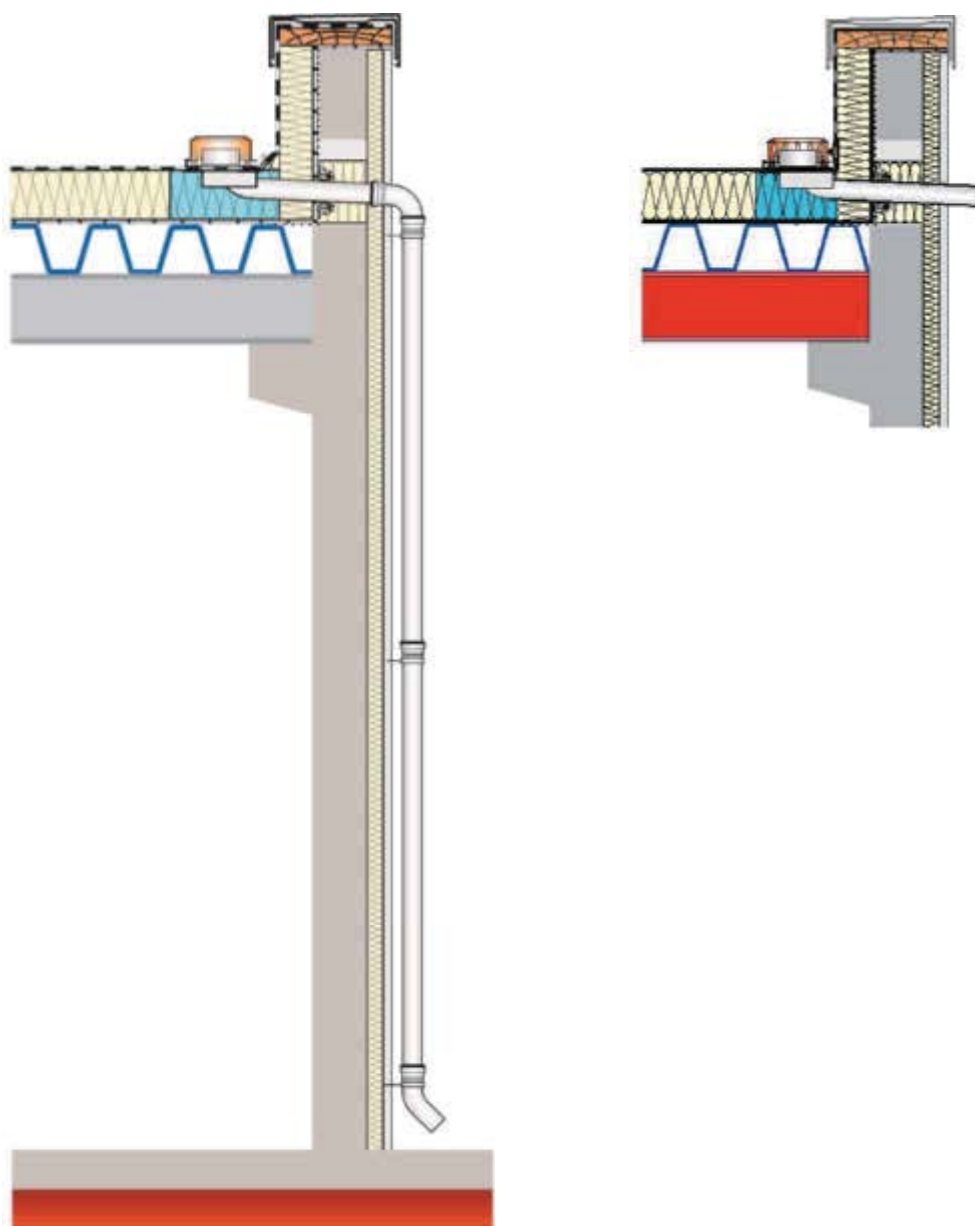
Notenauflauf mit freiem Auslauf durch die Fassade auf schadlos überflutbare Grundstücksflächen
